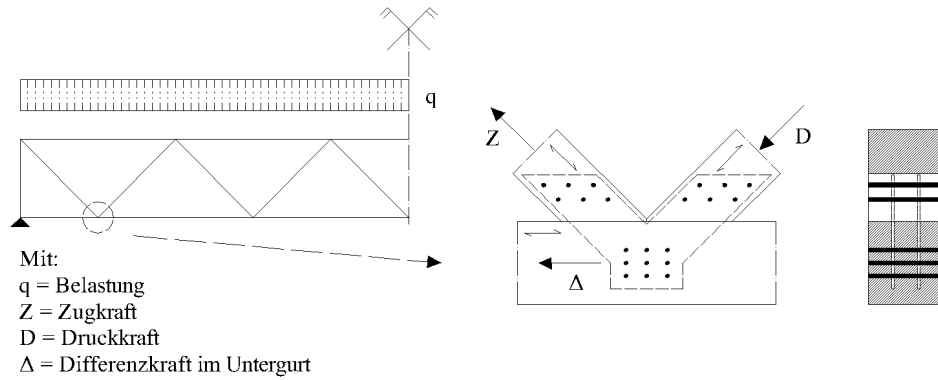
Detail Fachwerkträgerknoten mit Stahlblech-Holzverbindungen
